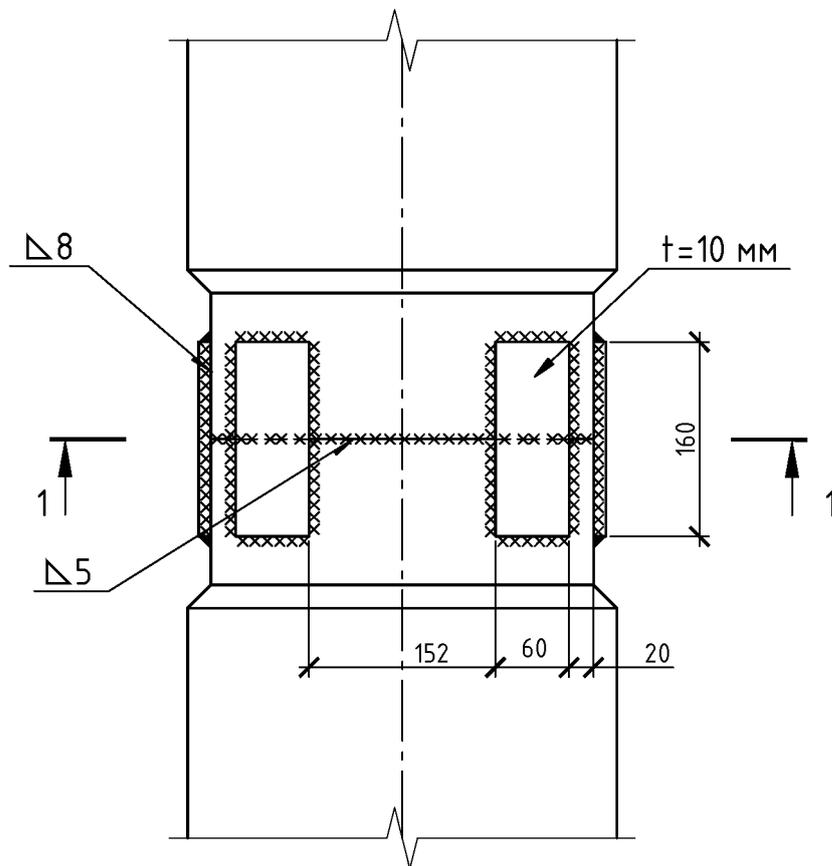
Схема сварки секций свай первого типа армирования
